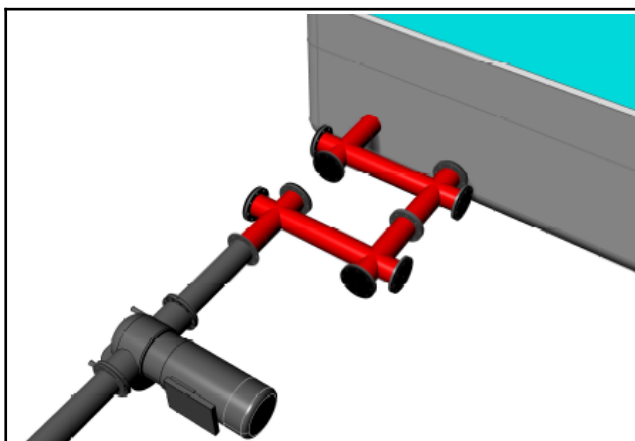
Installazione Esterna al serbatoio per Sistema UltraLED Water 2000/2 (disegno stilizzato)
